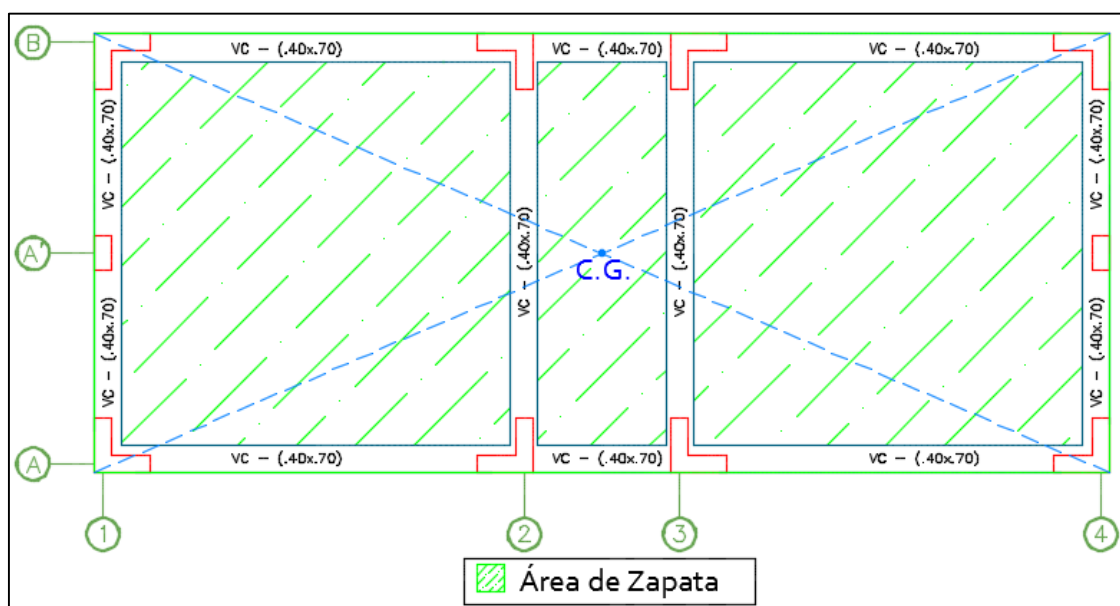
Área de contacto losa de cimentación - Sistema aporticado
